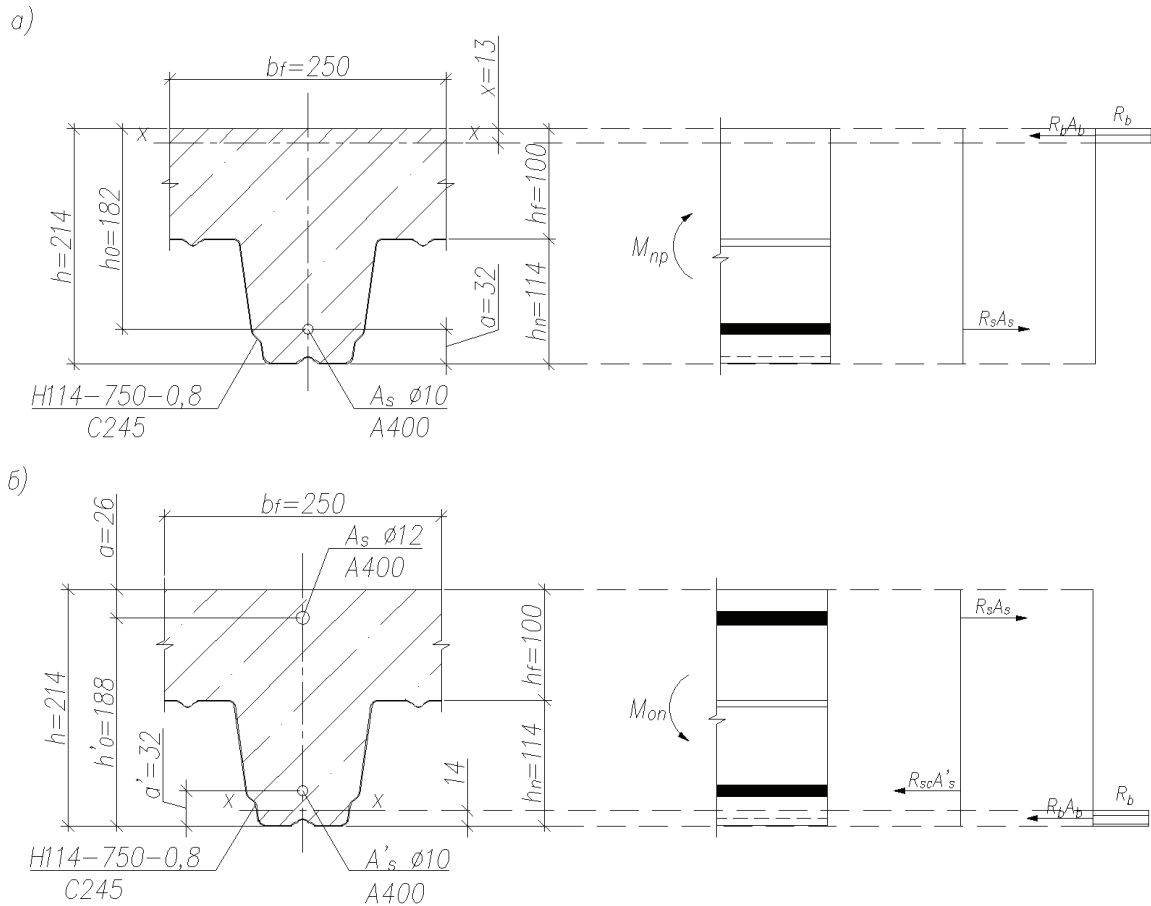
Сечение и схема усилий 1-го варианта: а) в пролете; б) над промежуточной опорой
